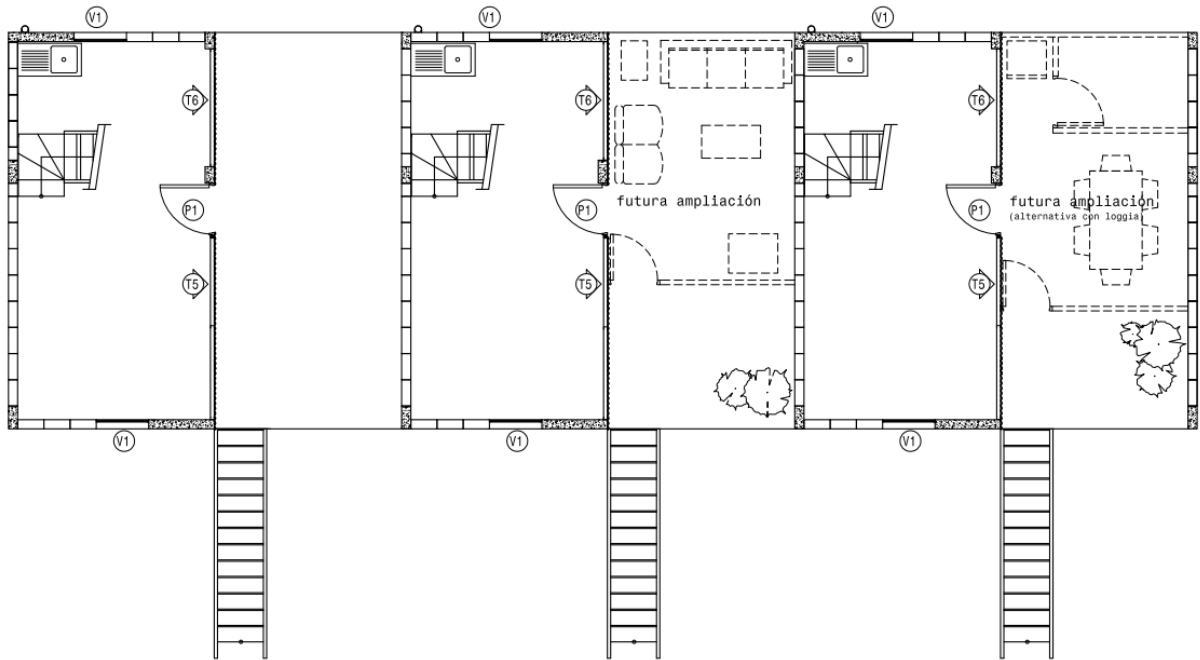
Planta segundo nível. Fonte: Projeto Elemental – Quinta Monroy, 2016.
